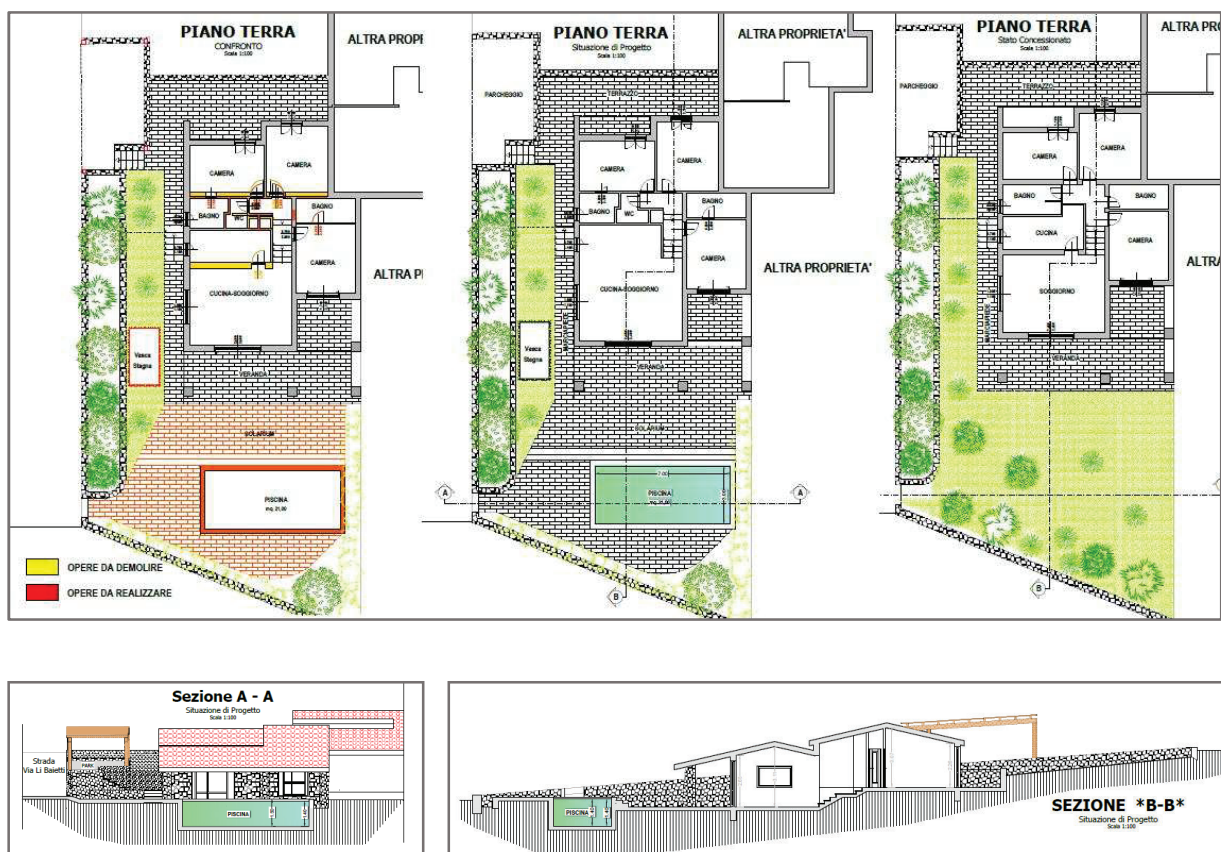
Confronto planimetrico tra stato di progetto con opere interne, vasca reflui, piscina/solarium, pergola e stato concessionato
